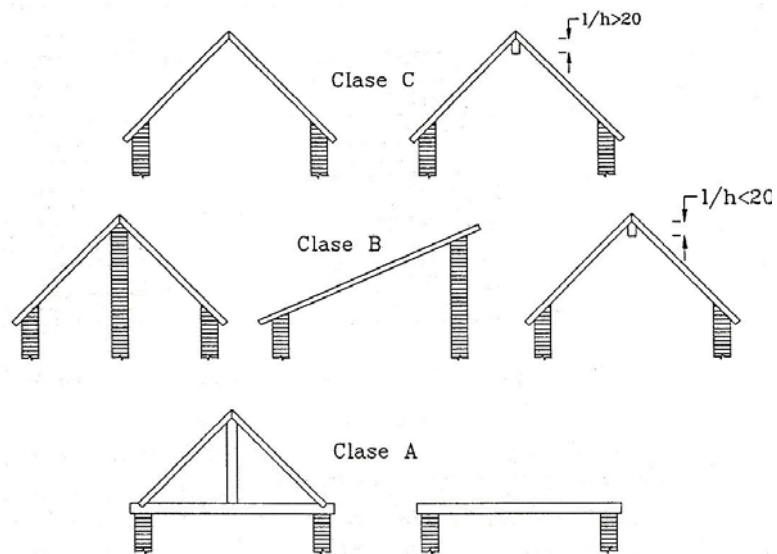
Tipologías de Cubiertas (Yepez 1996)
